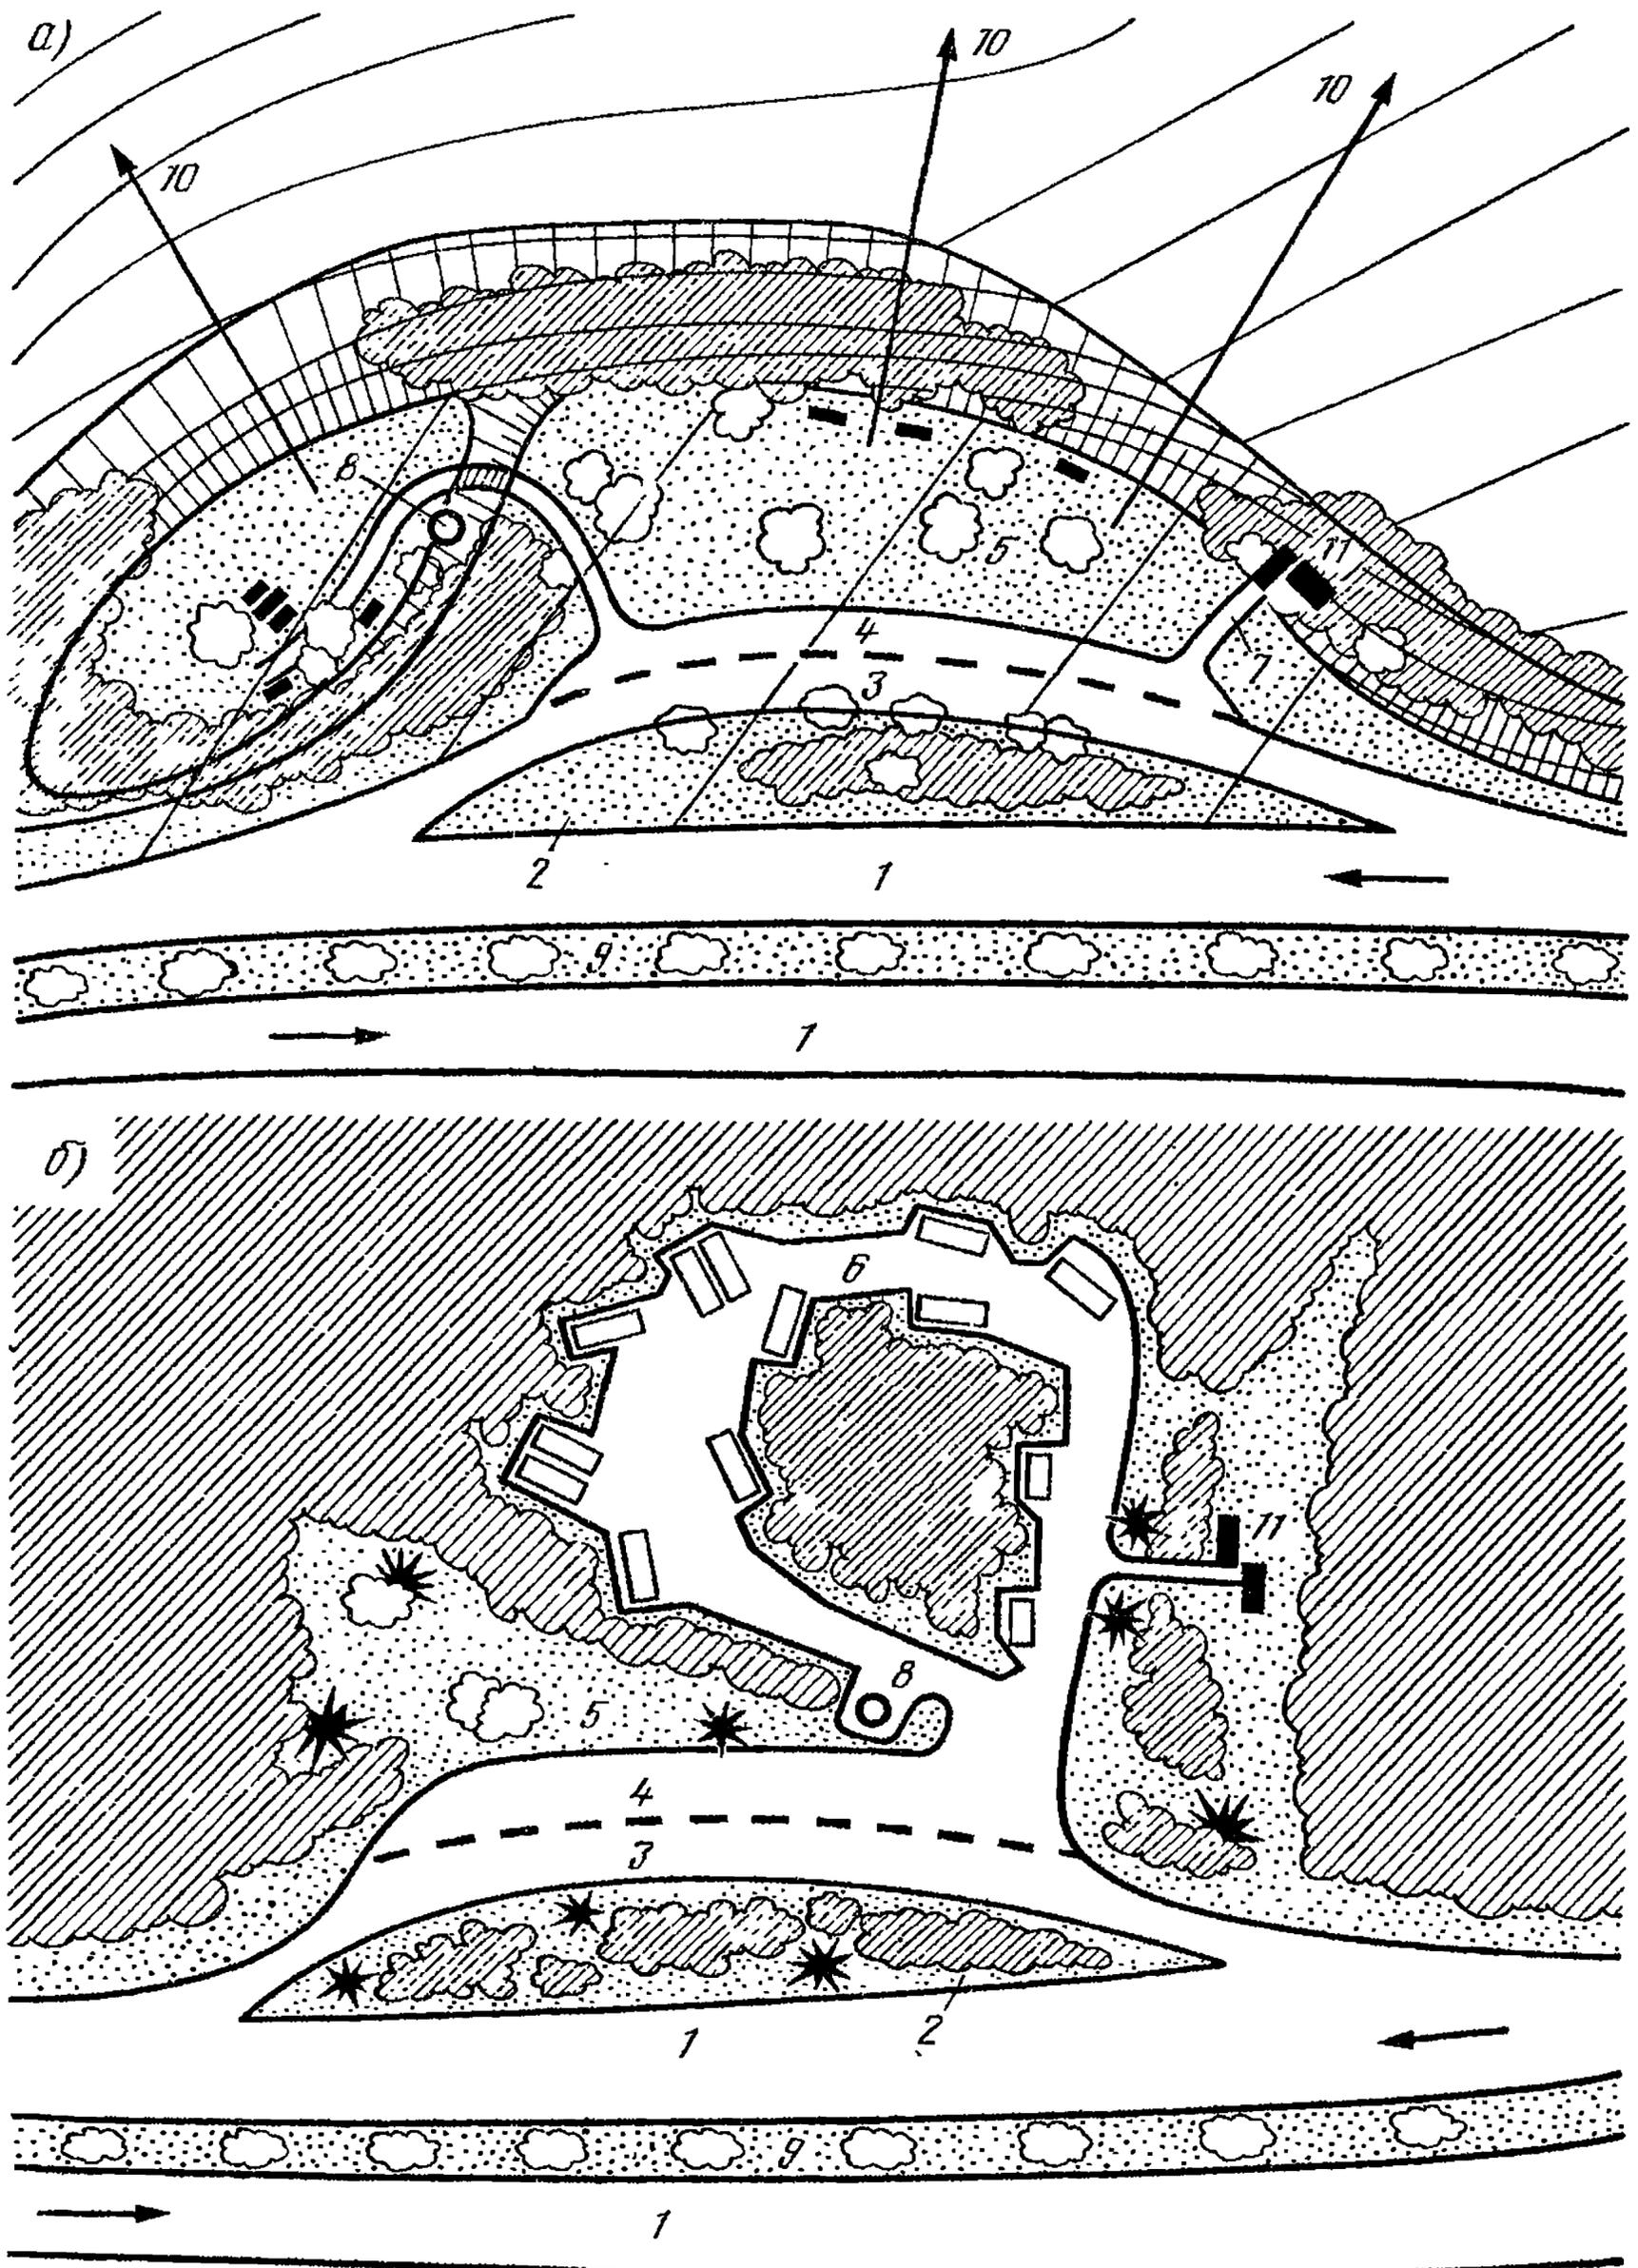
Наиболее распространенные схемы площадок отдыха:
